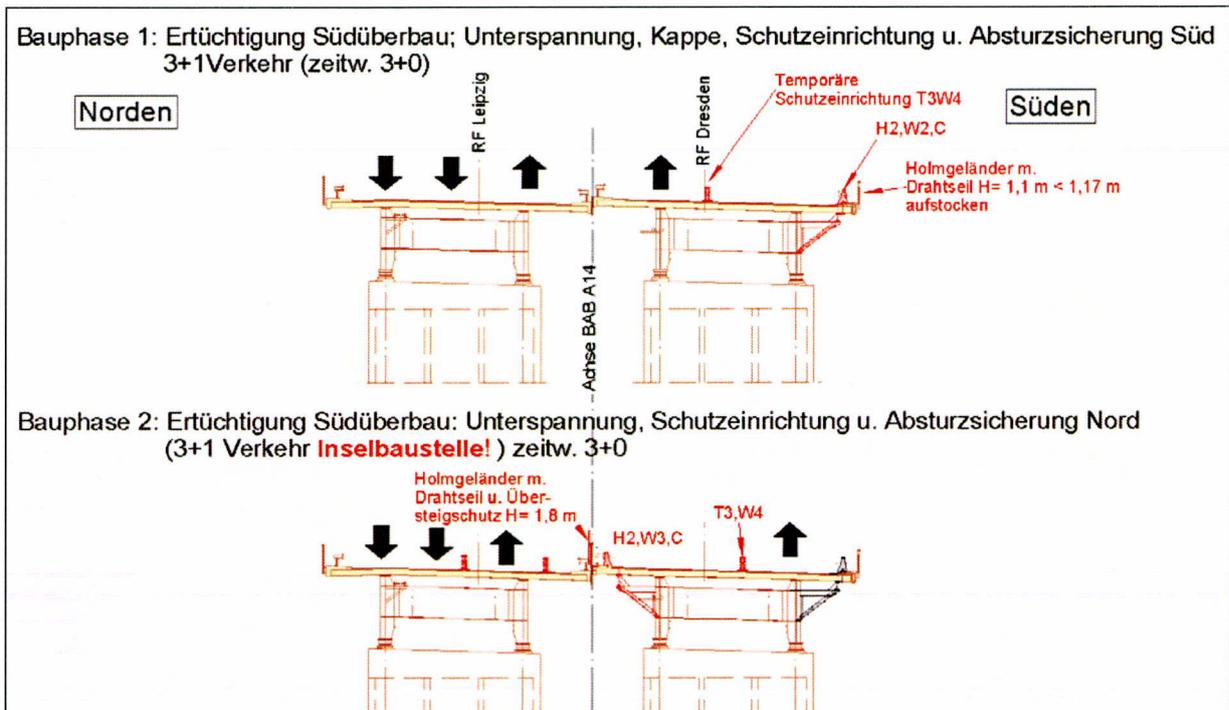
Bauvariante 1 mit der erforderlichen bauzeitlichen Verkehrsführung
